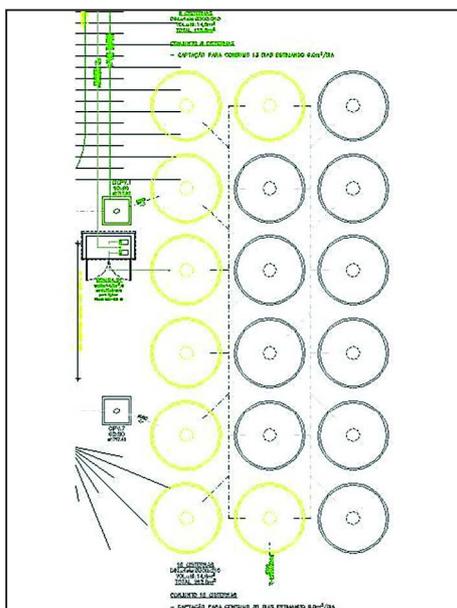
Cisternas para armazenamento, tratamento e reutilização de águas pluviais (fonte: Projeto de Drenagem e Instalações Hidrossanitárias)
